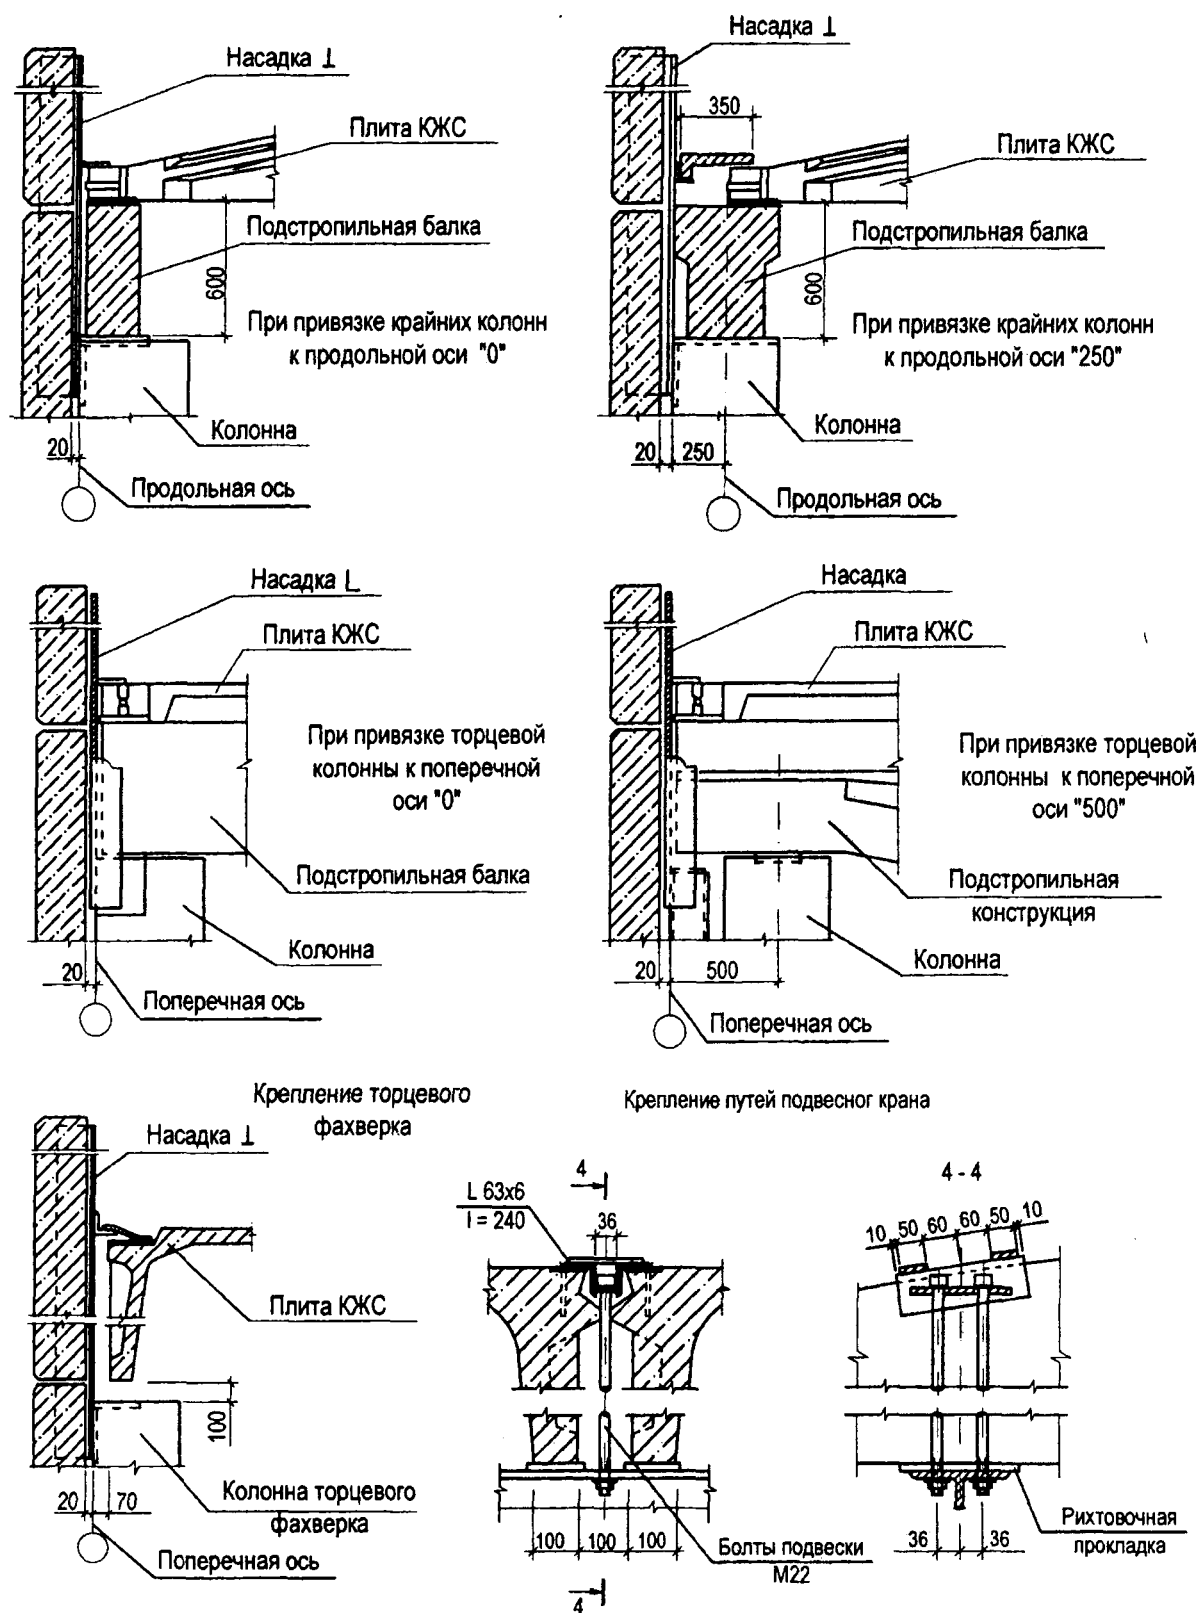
Опорные узлы и узел крепления путей подвесного крана к плитам КЖС
